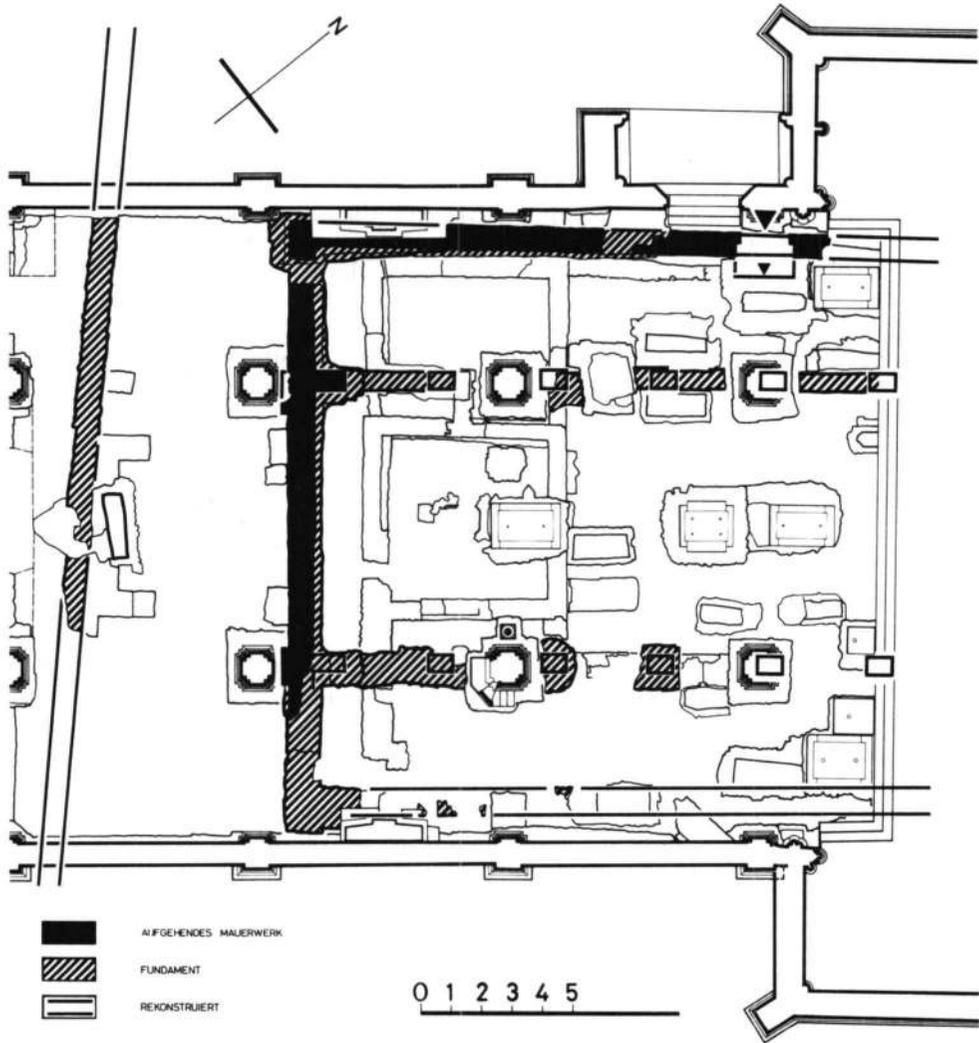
Anlage IV: rekonstruierter Grundriss (Massstab 1 : 250).
